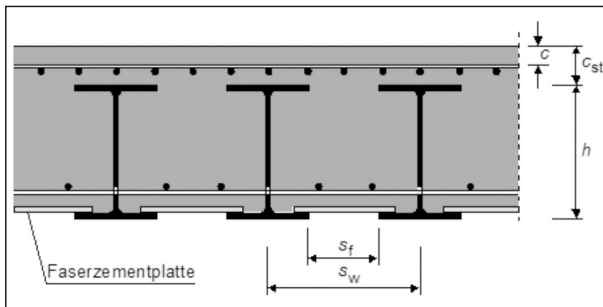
Querschnitt einer WiB-Brücke nach DIN-Fachbericht 104 [27]
